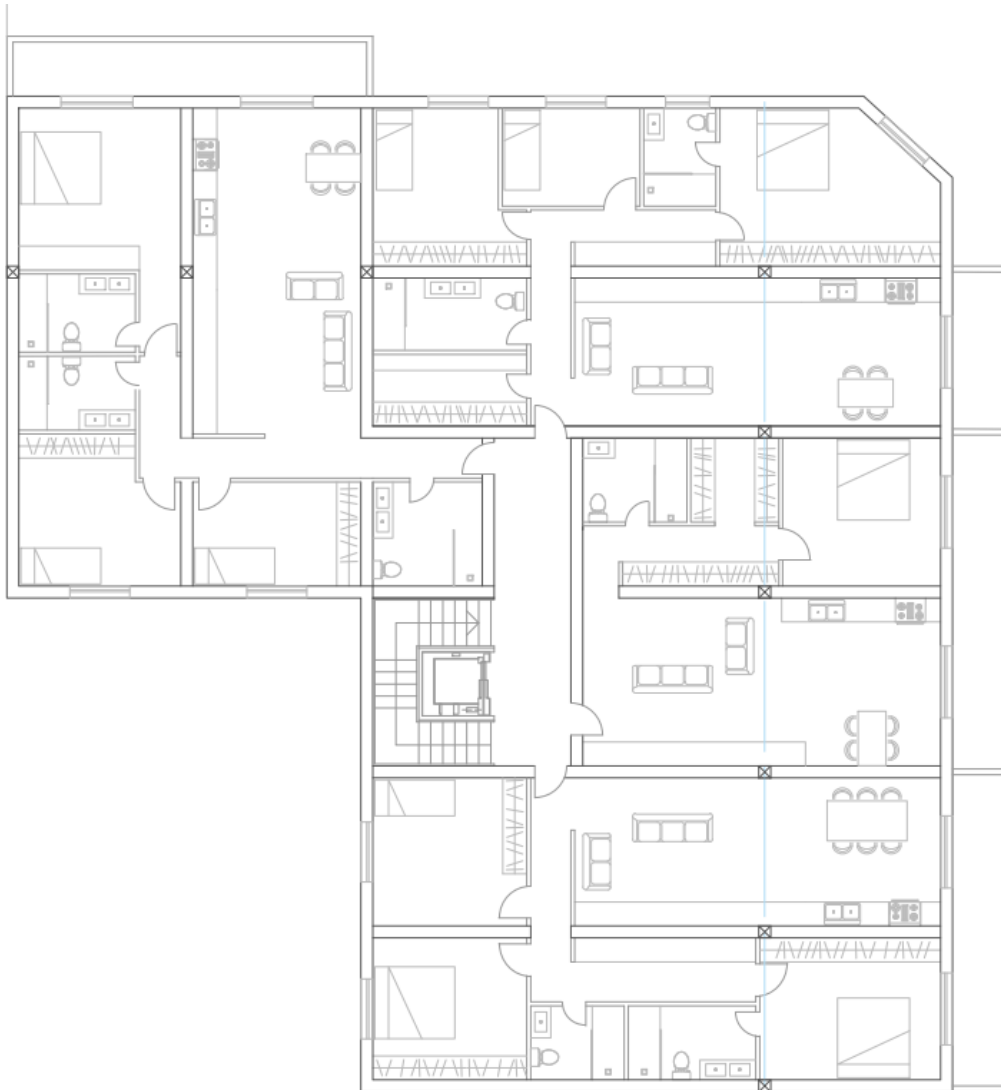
Planta de distribución del edificio tipo con estructura de entramado ligero de madera realizada en AutoCAD.
